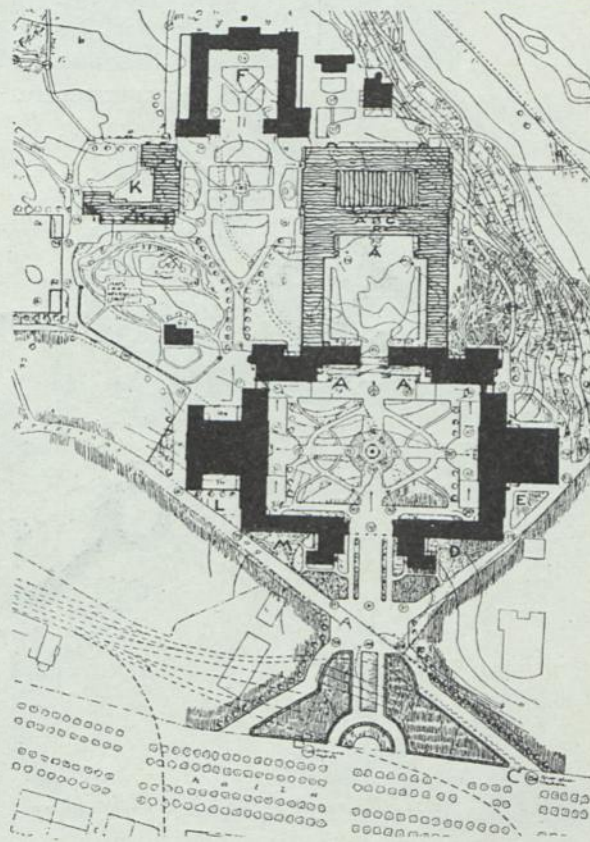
ANDRA PRIS: SITUATIONSPLAN.
